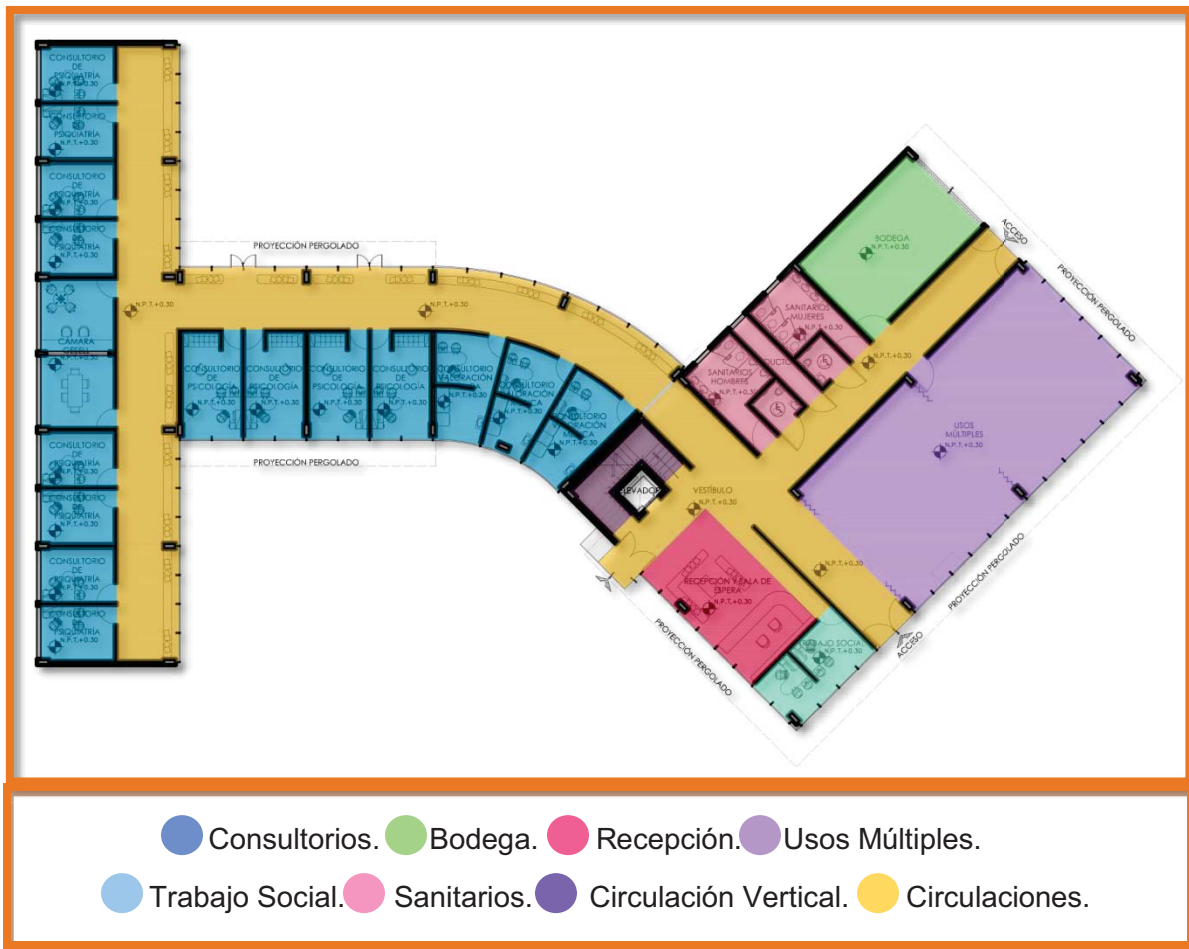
Zonificación de la Planta Baja del Edificio Principal.
